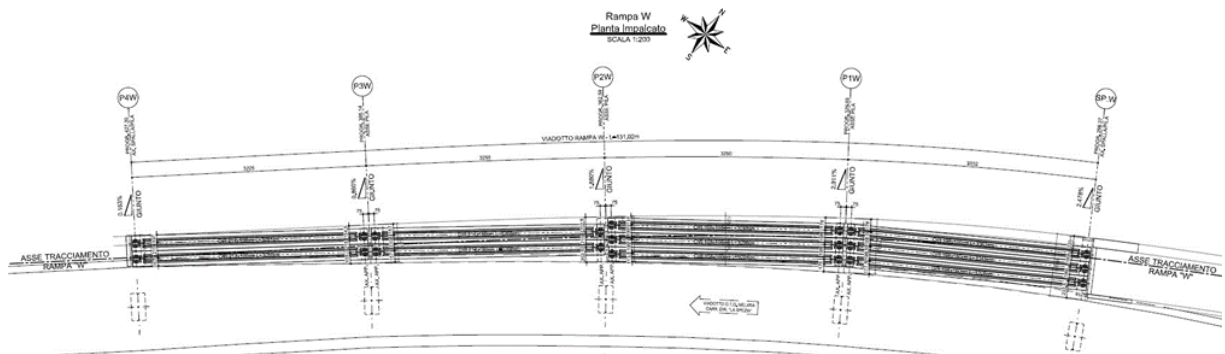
Planimetria Rampa W svincolo Melara
